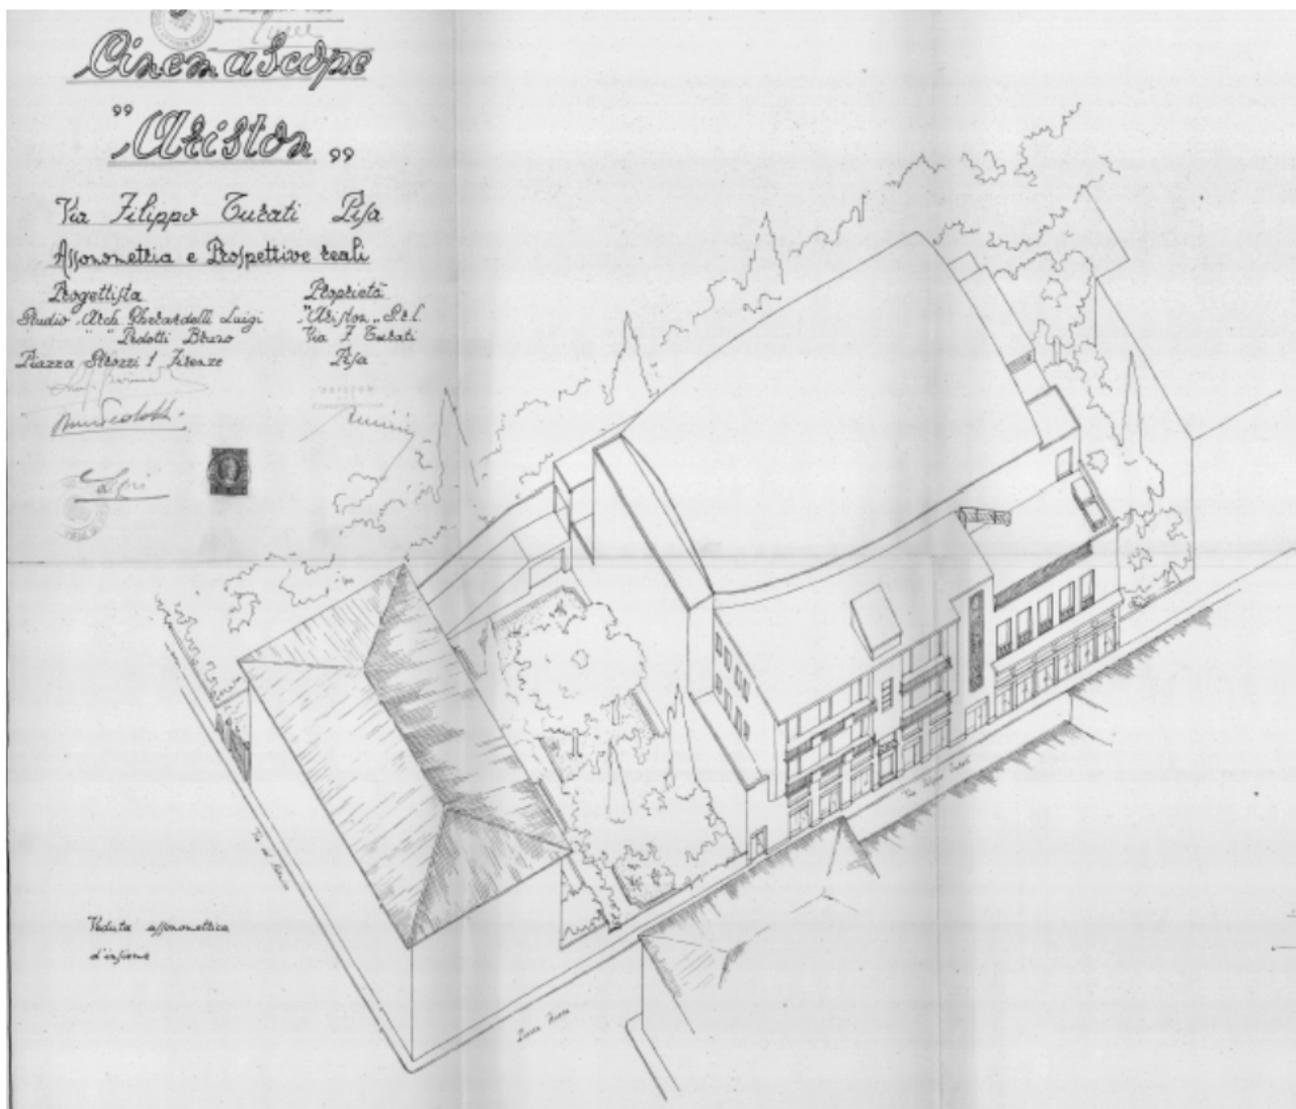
Progetto Cinema Scope Ariston - assonometria
